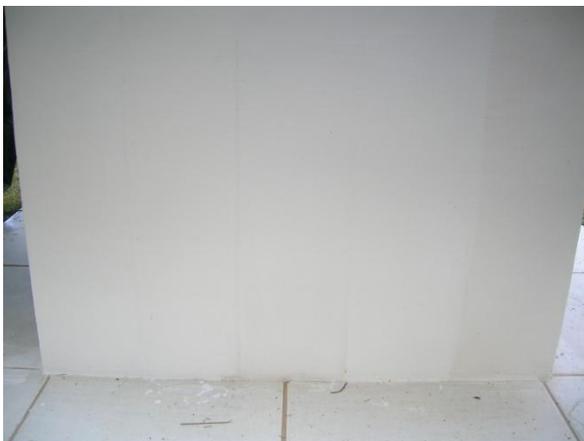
Aspecto de uma parede tipo após finalização da pintura. Fachada Norte. Fonte: autor (2009).
